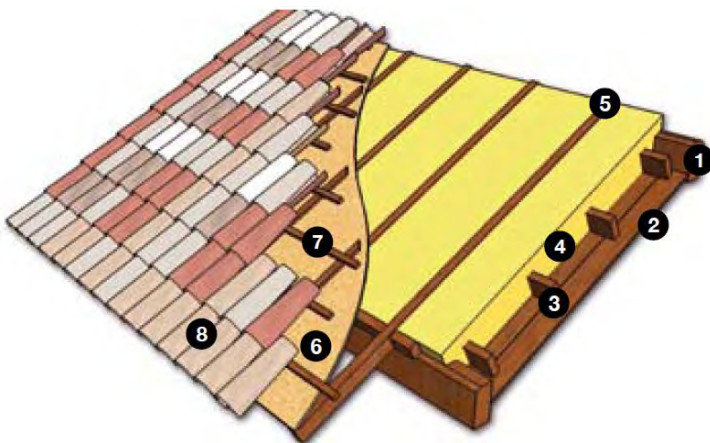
Esquema de hormigón de cáñamo en aislamiento de techumbre, estructura tradicional
